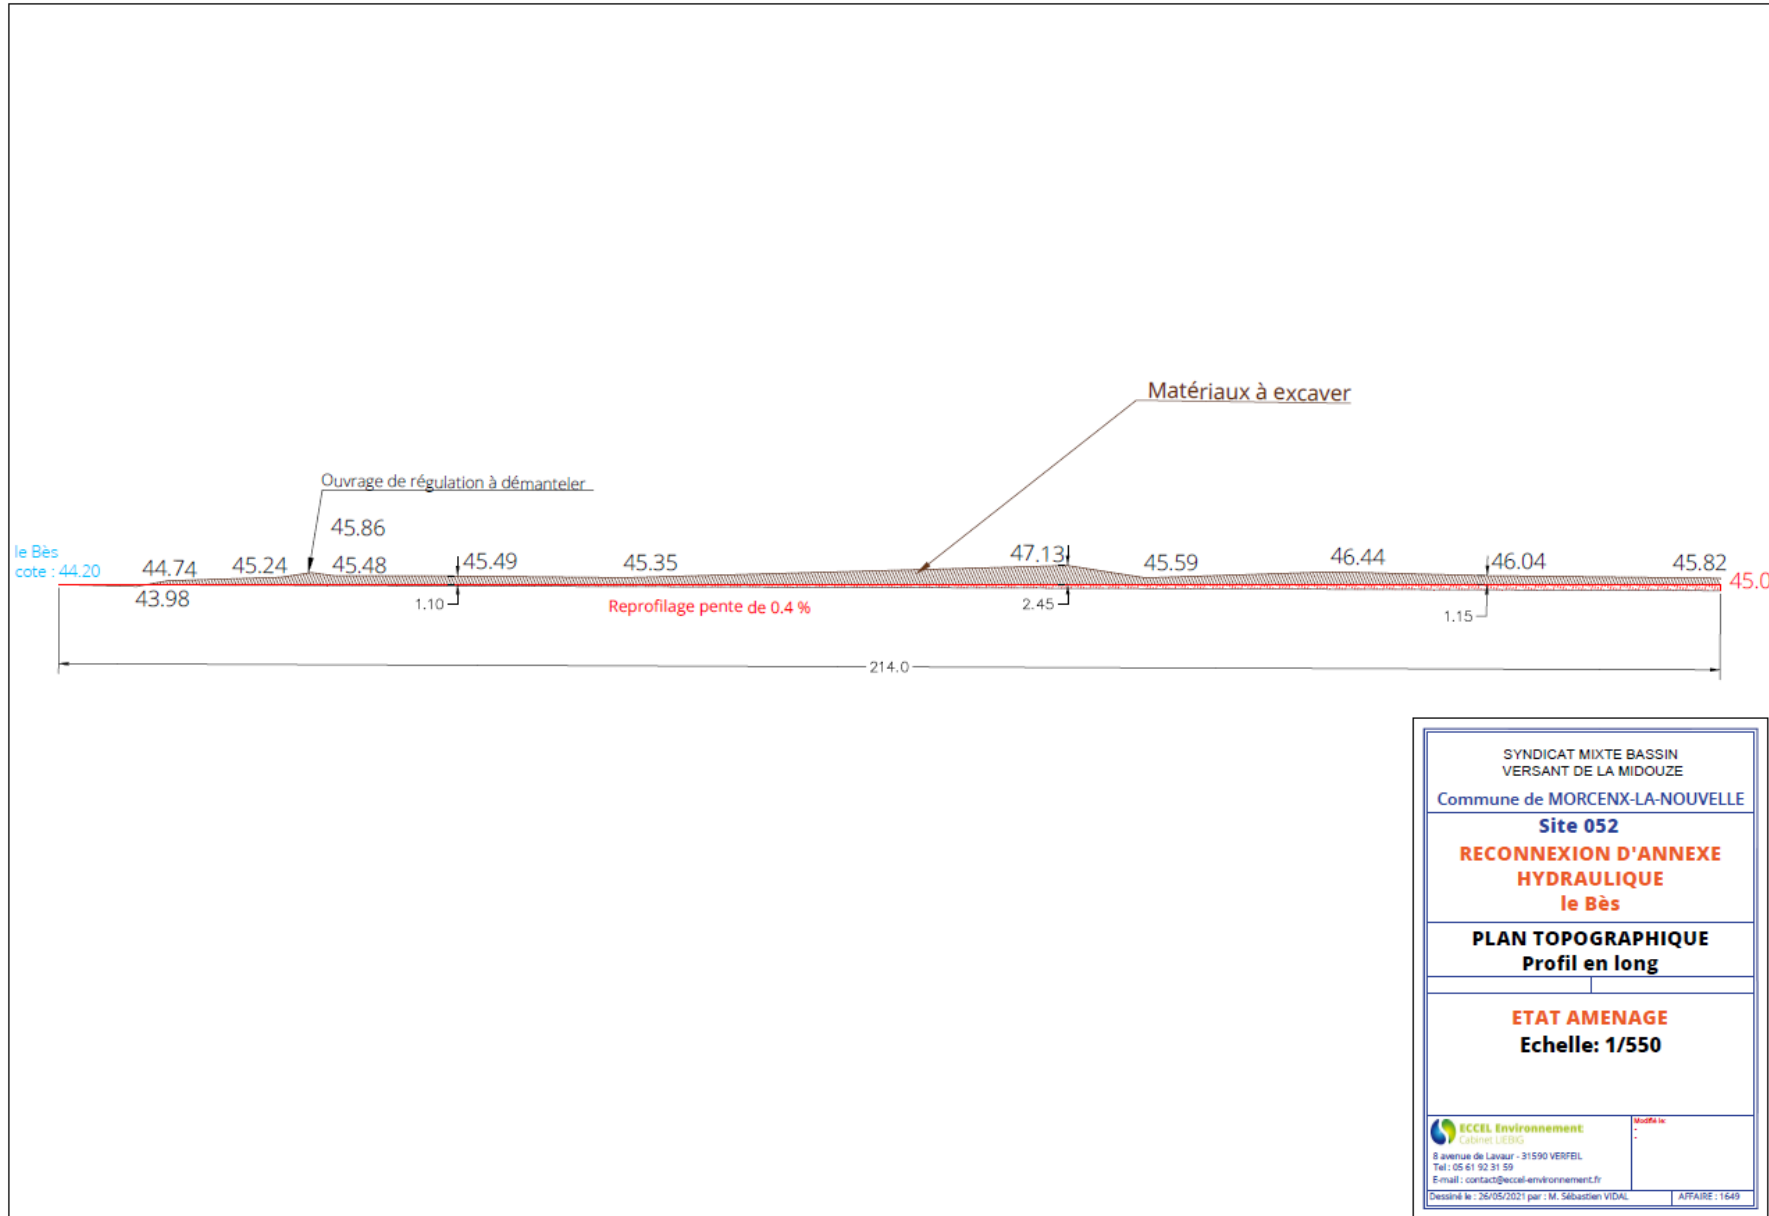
Profil en long – Etat aménagé – Site Be\_026
